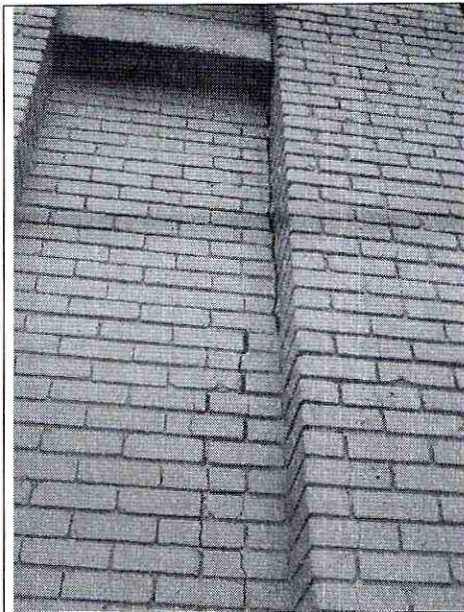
Vista, por el exterior, de la grieta de tendencia vertical de la zona central del muro.
